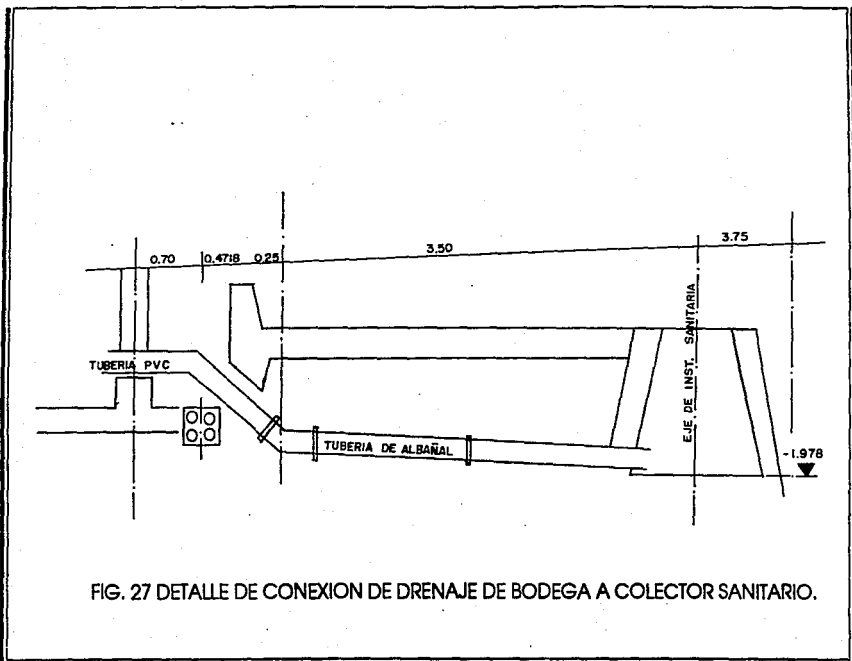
DETALLE DE CONEXION DE DRENAJE DE BODEGA A COLECTOR SANITARIO.
